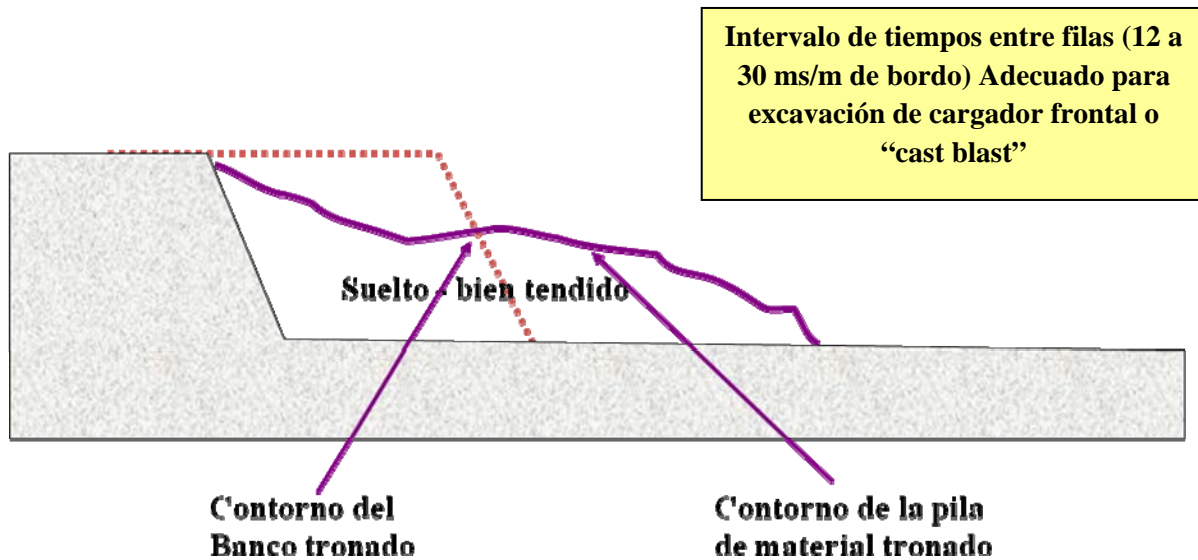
Esquema con 12 ms/m a 30 ms/m de retardo entre filas de barrenos
